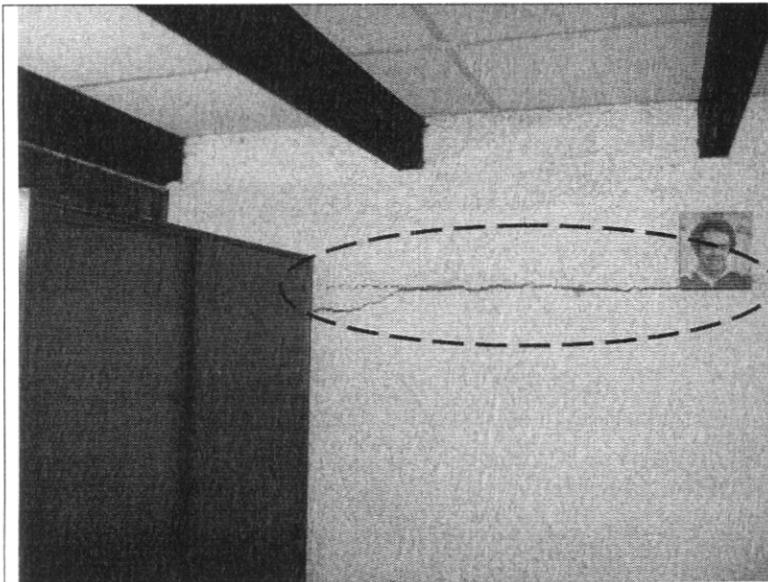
Agrietamientos diagonales en muro de mampostería de la parte posterior del predio de la Calle 97A No. 10-50.
